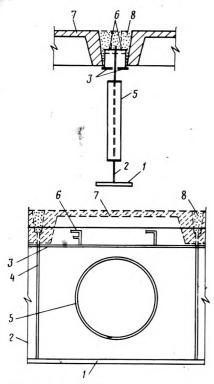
Конструктивное решение сталежелезобетонных балок перекрытий под большую временную нагрузку
